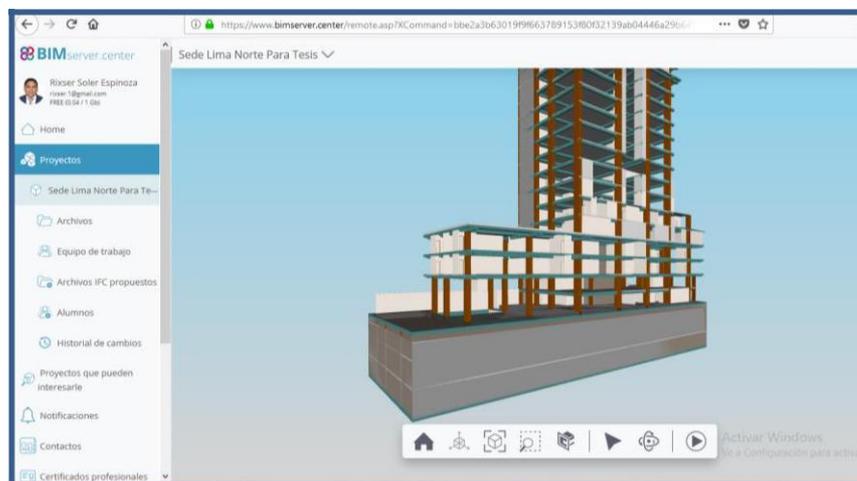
Diseño arquitectónico en 3D modificado en IFCbuilder 02
